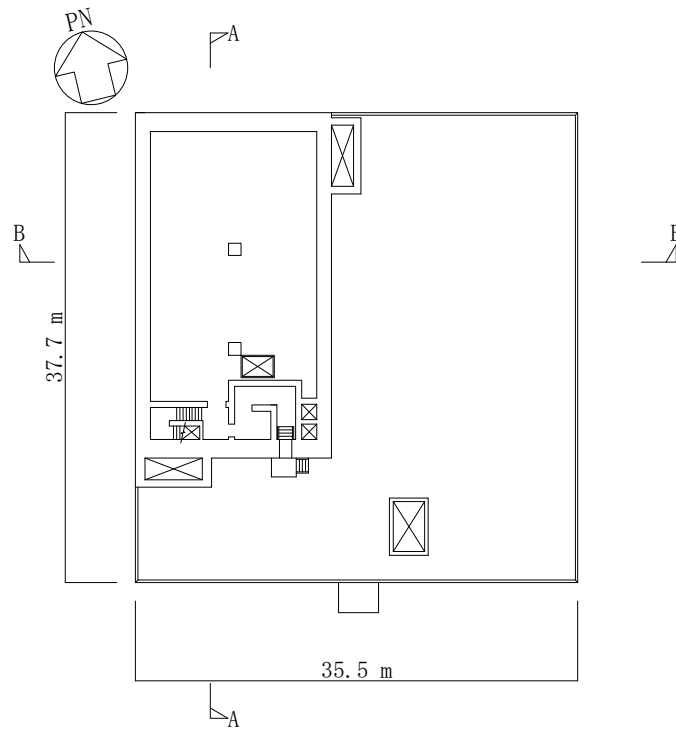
(4/5) 緊急時対策所建屋の概略平面図 (4 階平面図 : EL. 43.5 m)
